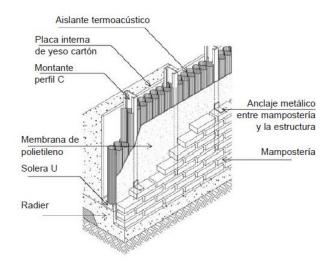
Esquema de mampostería aplicada al Steel Framing. Fuente: (Alacero, 2014).
